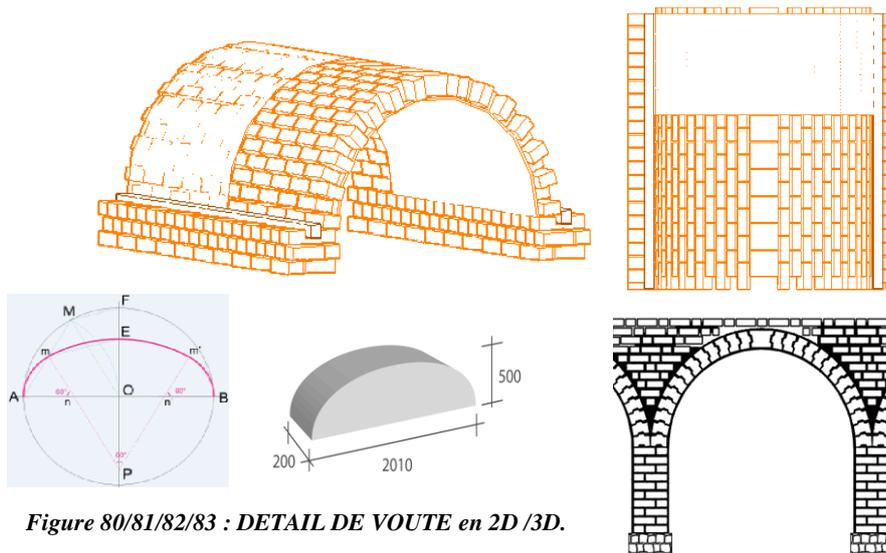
/81/82/83 : DETAIL DE VOUTE en 2D /3D.
